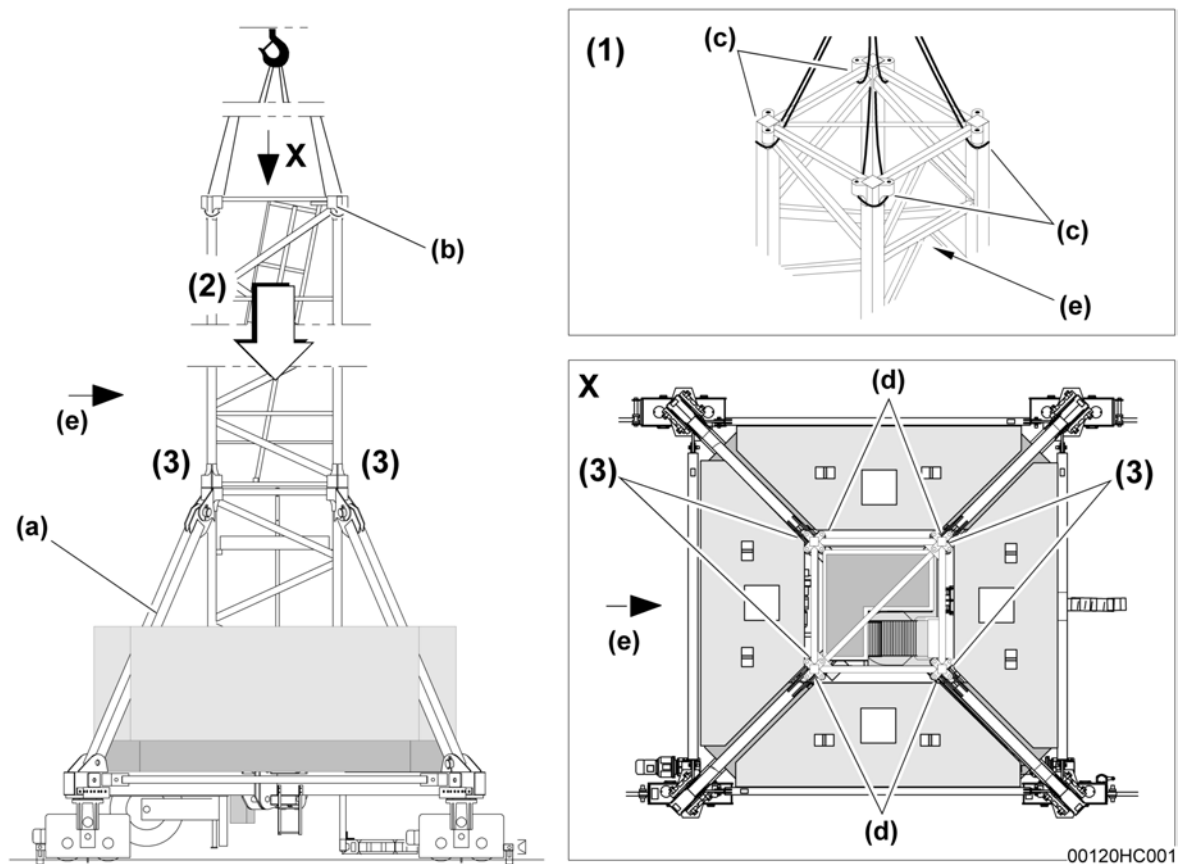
Grundturmstück auf den Unterwagen montieren
